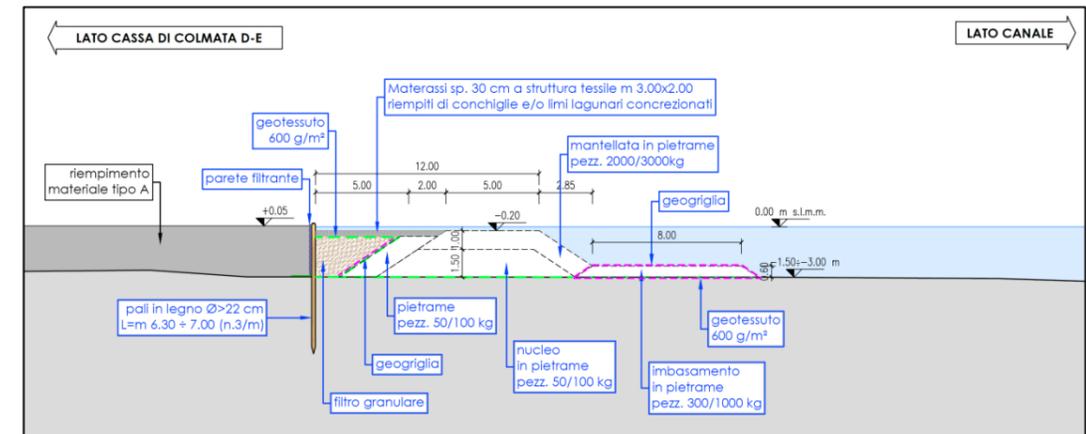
sezione tipo fronte Cassa di Colmata D-E
